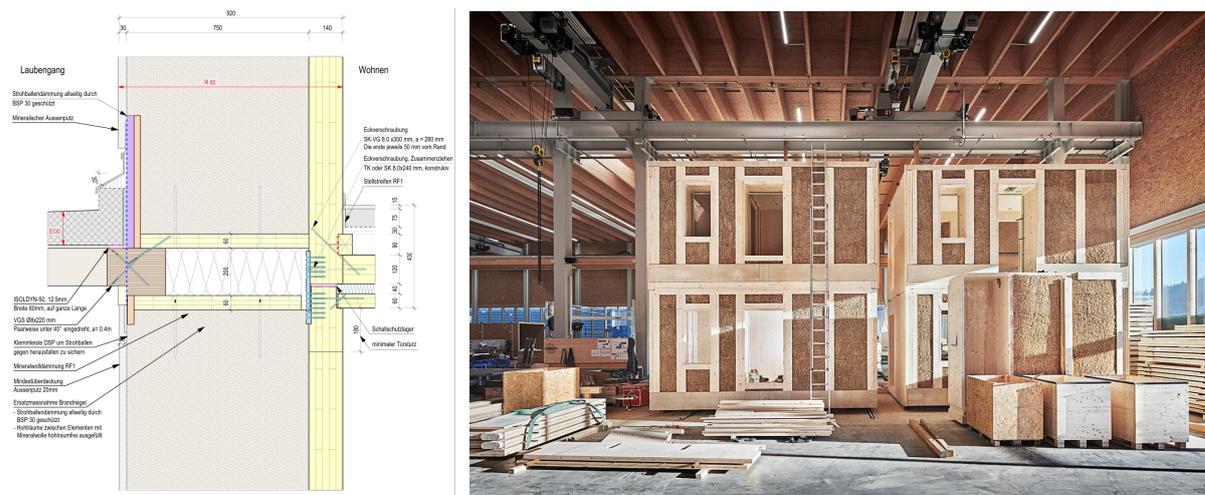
Aussenwandkonstruktion als Kombination von Holzrahmen- und Brettsperrholzbauweise (Strohdämmung)
